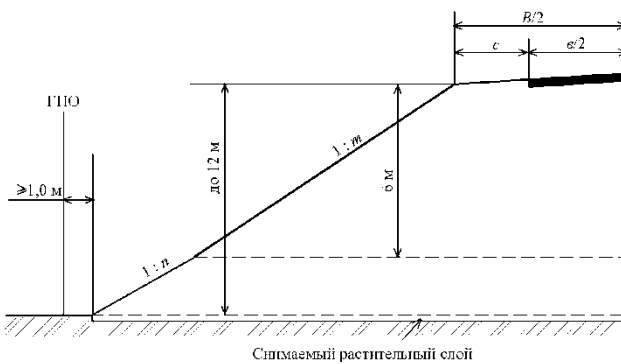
Поперечный профиль земляного полотна насыпи при высоте насыпи до 12 м
